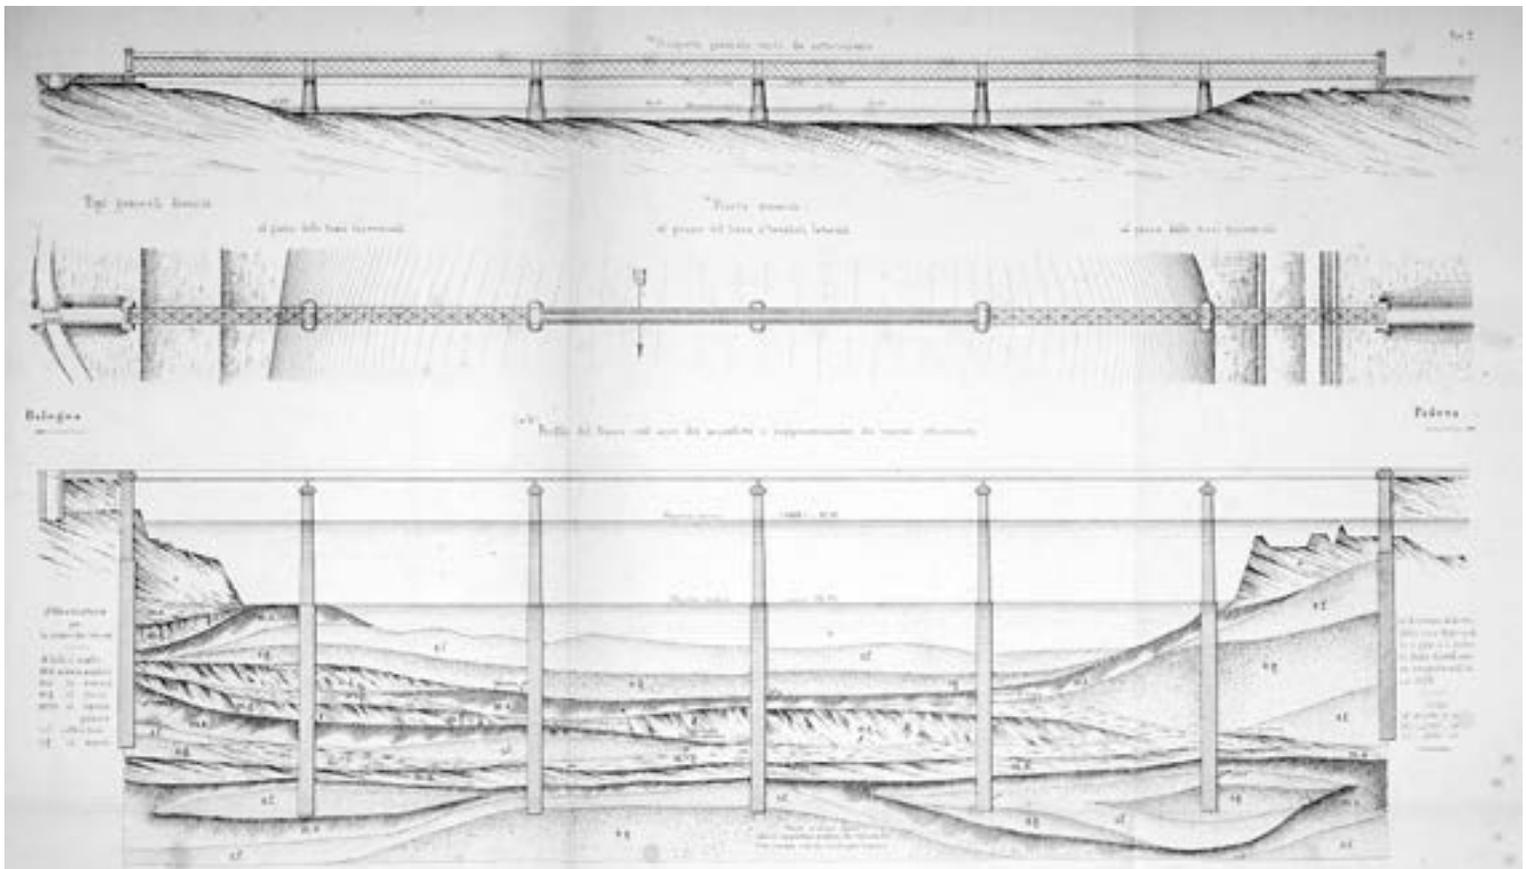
| Ponte a Pontelagoscuro: tavola di progetto con indicazione della profondità delle fondazioni pneumatiche e stratigrafia del terreno (Ratti, 1876).
